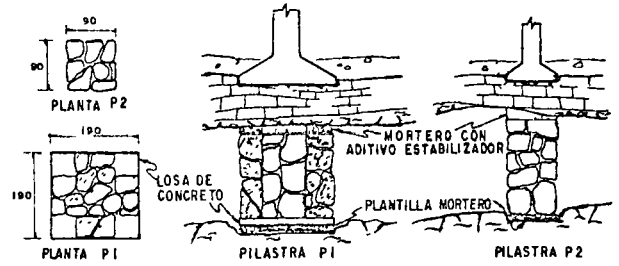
Pilastras de mampostería debajo de zapatas secundarias y refuerzo de la bóveda.
